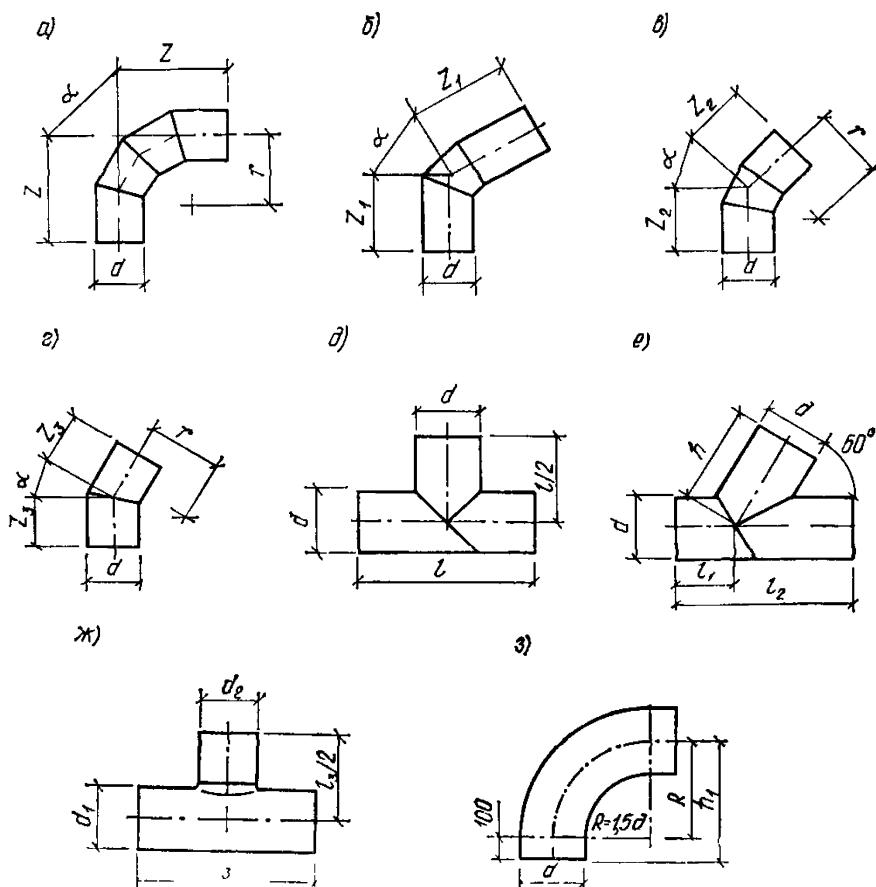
Соединительные детали из ПНД, получаемые из отрезков труб:
